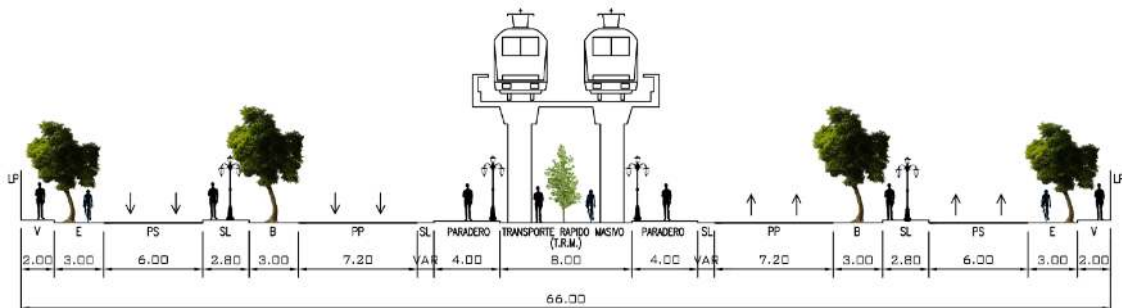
Propuesta de sección vial Av. Próceres de la Independencia. Elaboración propia sobre sección vial aprobado. Instituto Metropolitano de Planificación.
